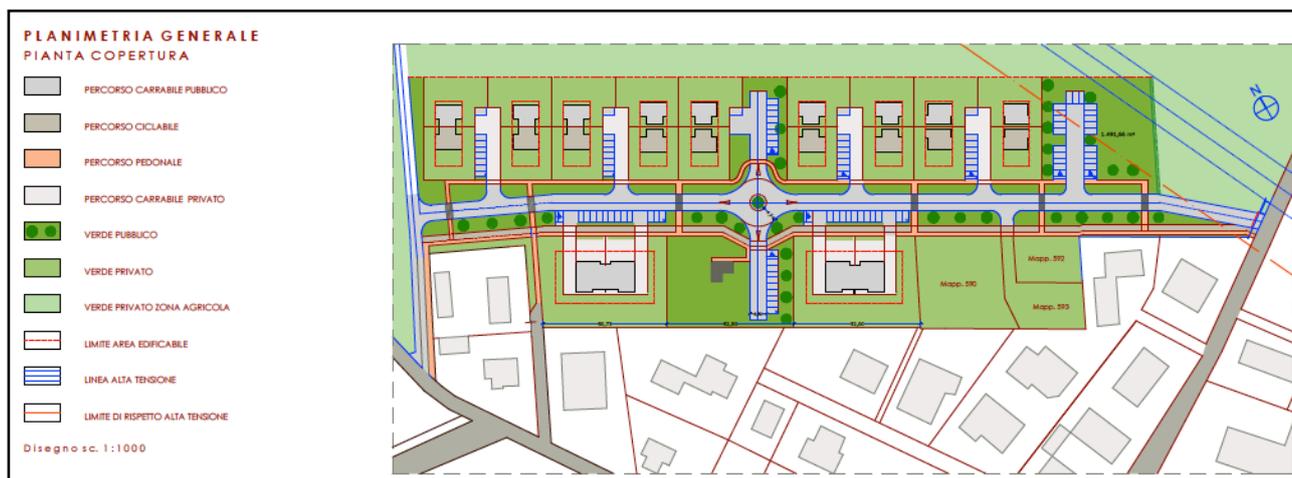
stralcio del progetto con planimetria delle opere edilizie.
